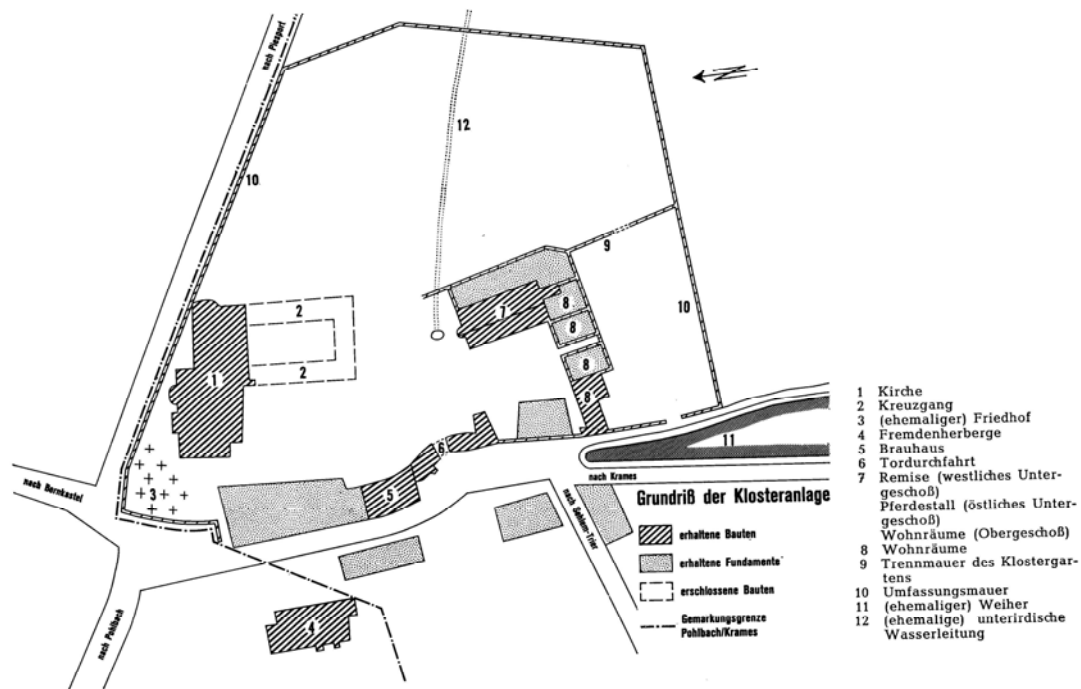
Grundriss der Klosteranlage von Eberhardsklausen (nach DOHMS [1968], S. 176a)
